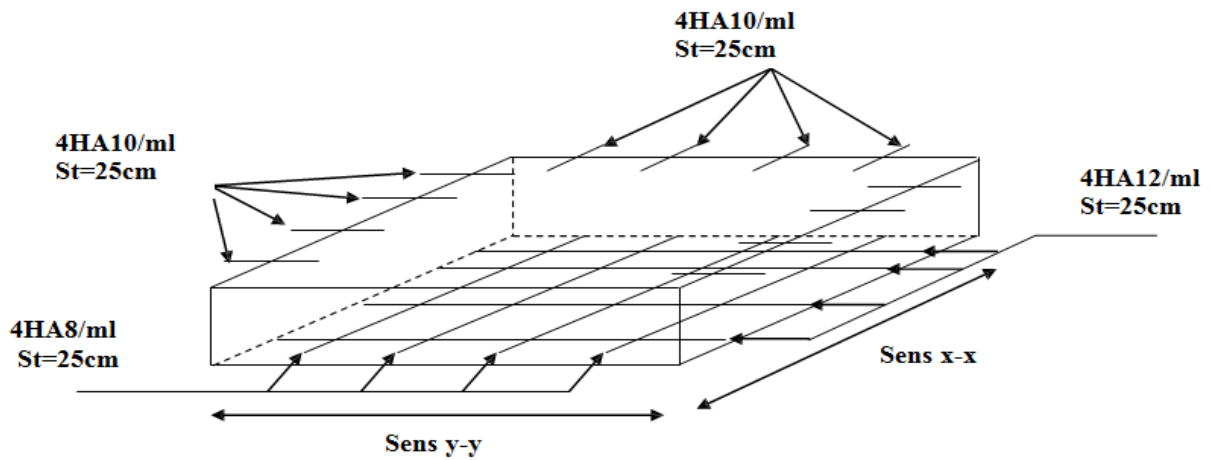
Schéma de ferrailage de la dalle sur trois appuis.
